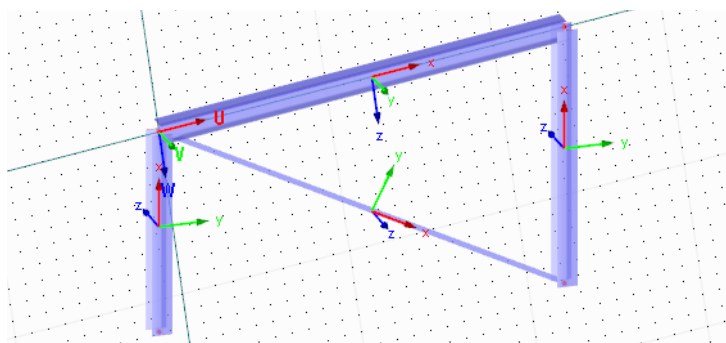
Plano de trabajo en la inclinación de la cubierta del eje xz de la barra
